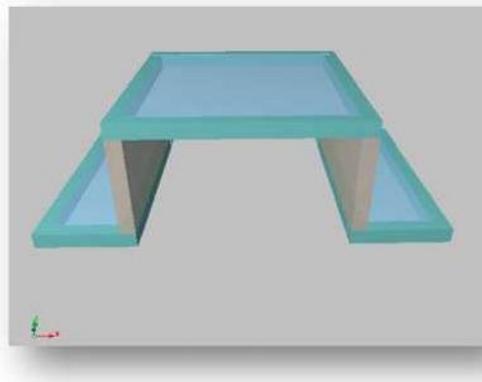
Esquema referencial de estructuración cajón de protección Gasoducto. Losa superior desmontable.
